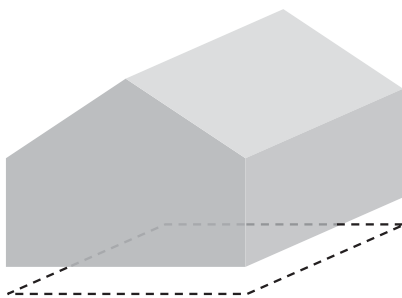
Проводник, заглубленный ниже уровня фундамента (не в бетоне)
